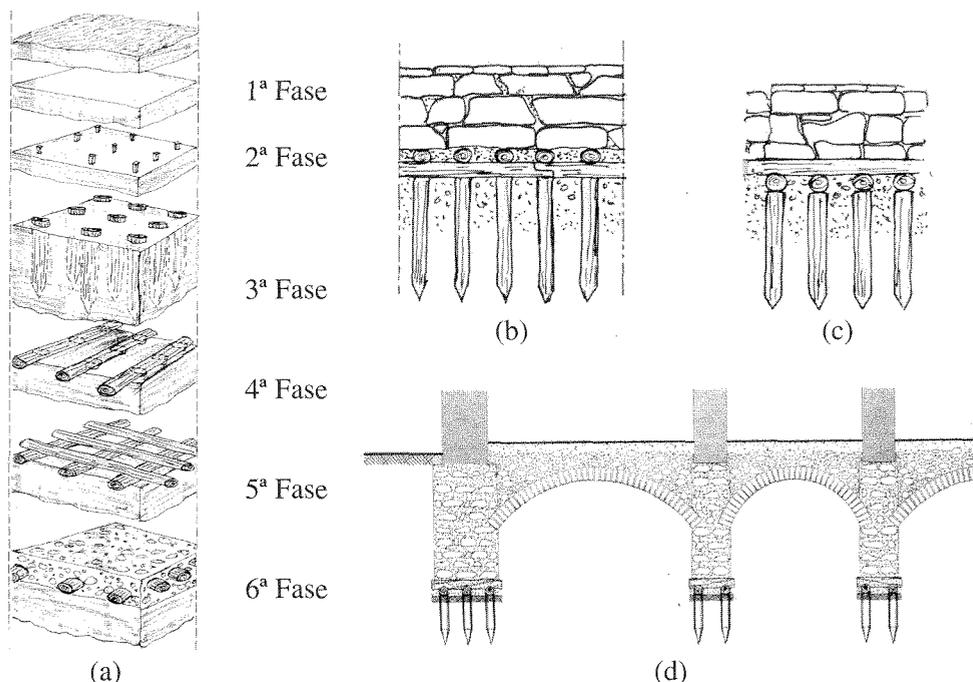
Fundações dos edifícios: (a) fases de execução; (b) corte longitudinal; (c) corte transversal; e (d) pormenor das ligações entre as paredes e pilares às fundações
